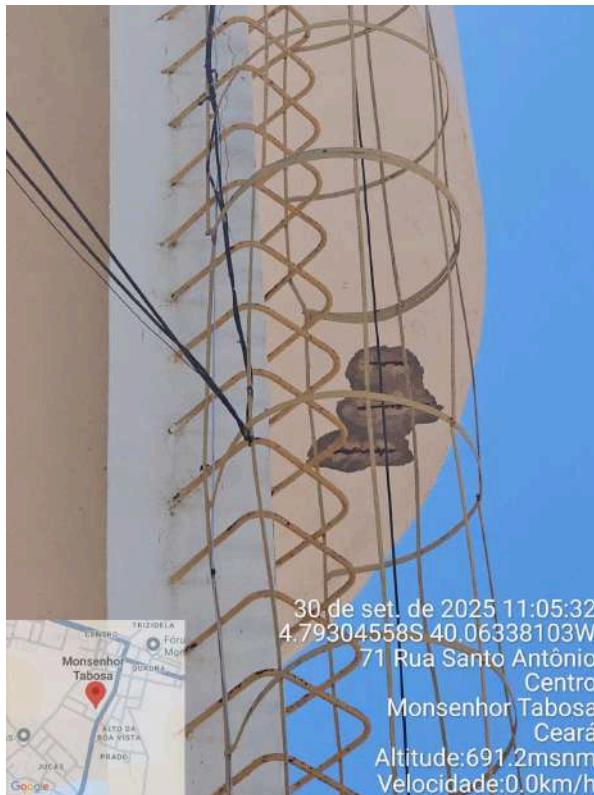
REL-03 (área privada): fechamento com rachaduras e armadura aparente.
